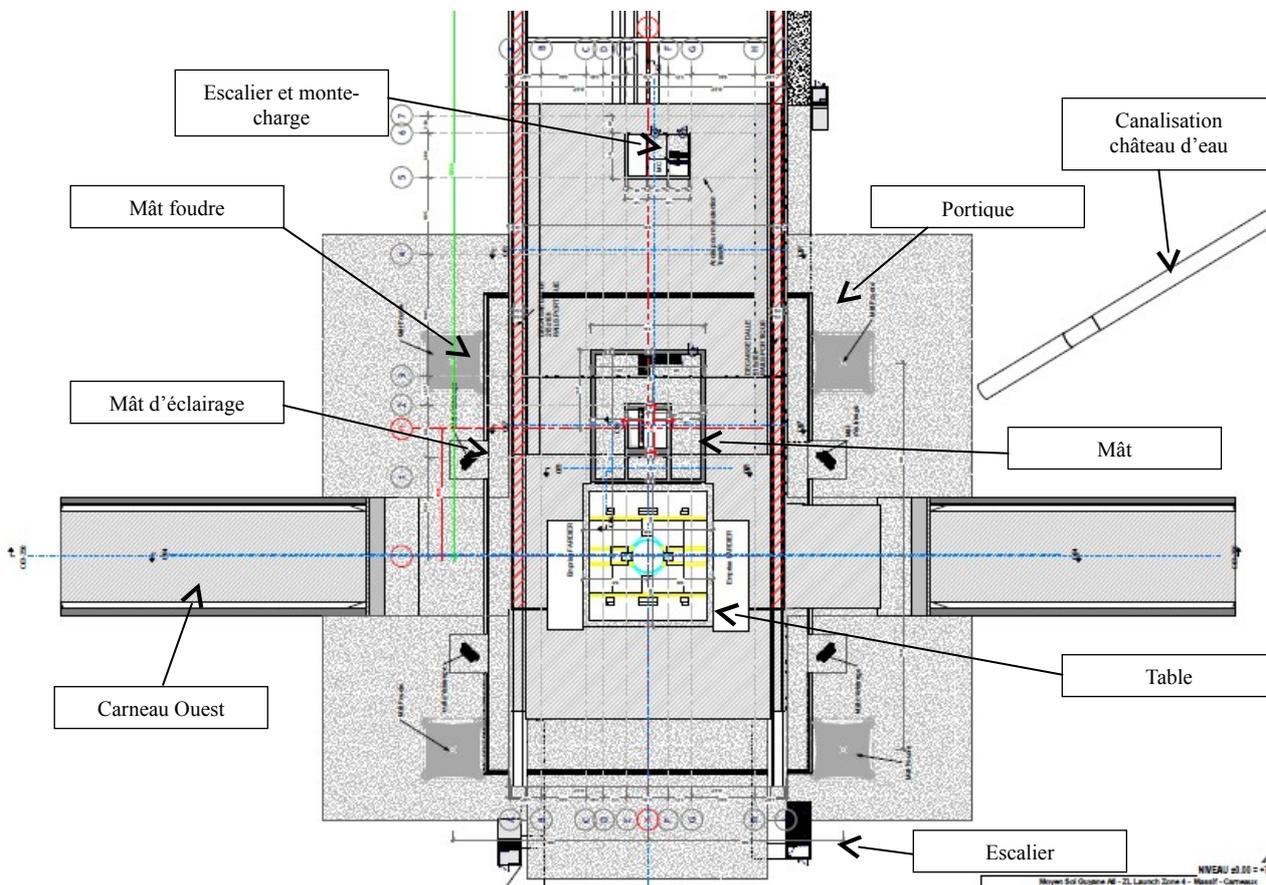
Plan Massif-carneaux niveau 0 (plan 3821-XD-1739-004-RDP-C)
